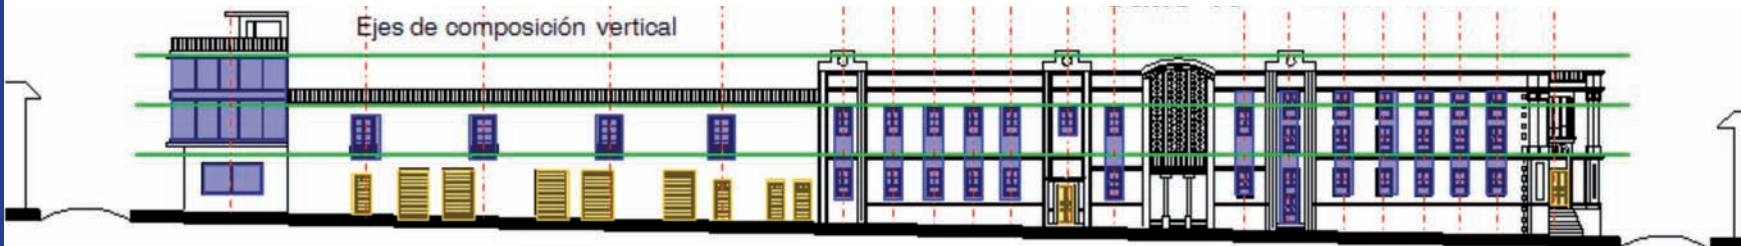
//Levantamiento de fachada, Carrera 22 entre calles 18 y 19 - área de estudio//
